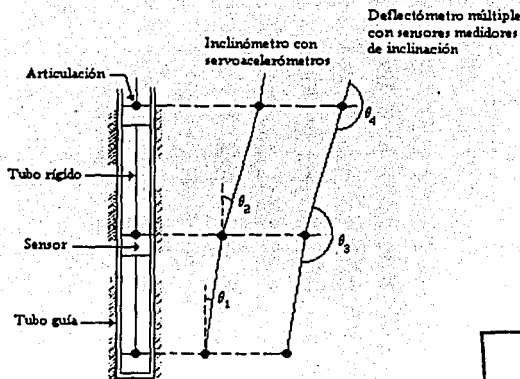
Esquema de un inclinómetro in situ y un deflectómetro múltiple
